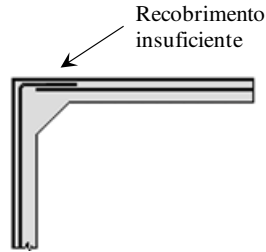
Aparecimento de fissuras devido ao reduzido recobrimento na zona de sobreposição de armaduras
